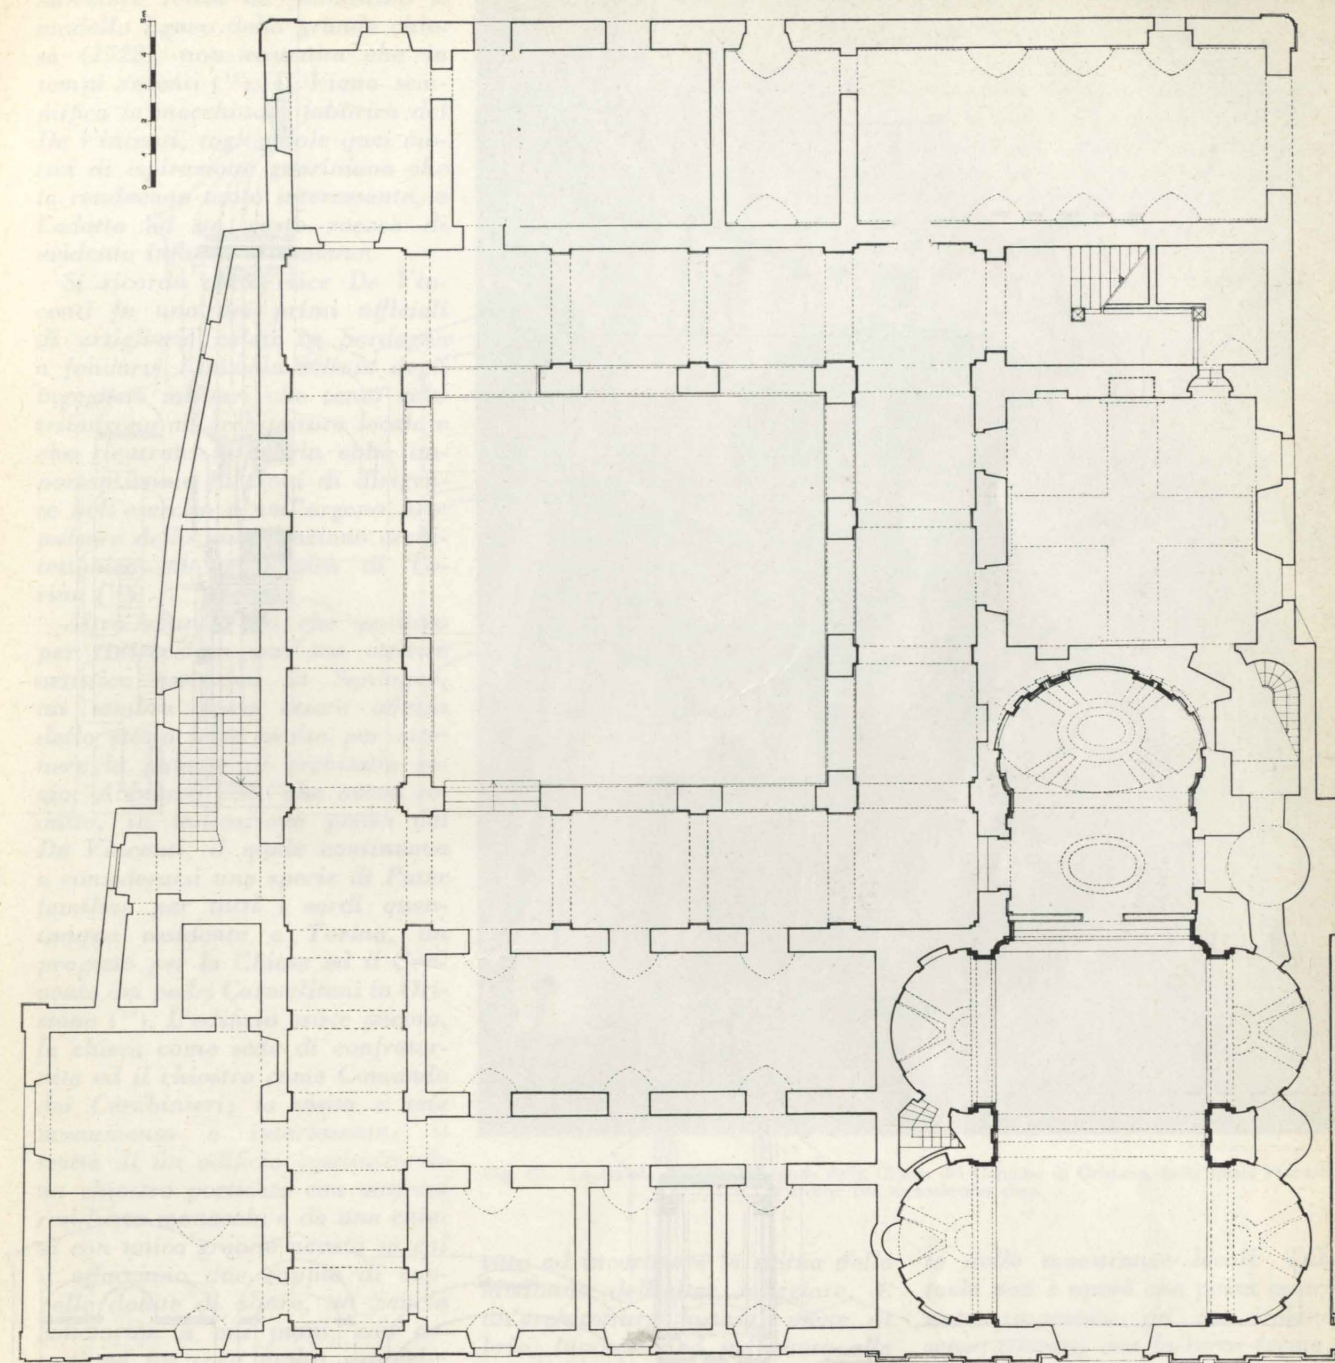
Rilievo di Mauro Cabras del Convento del Carmine in Oristano. Planimetria.
